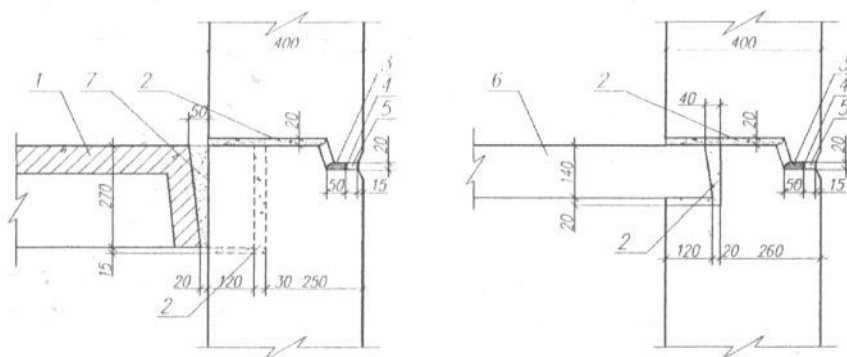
Примыкание шатровой панели к наружным стенам и опирание плоской панели перекрытия на наружные стены.
